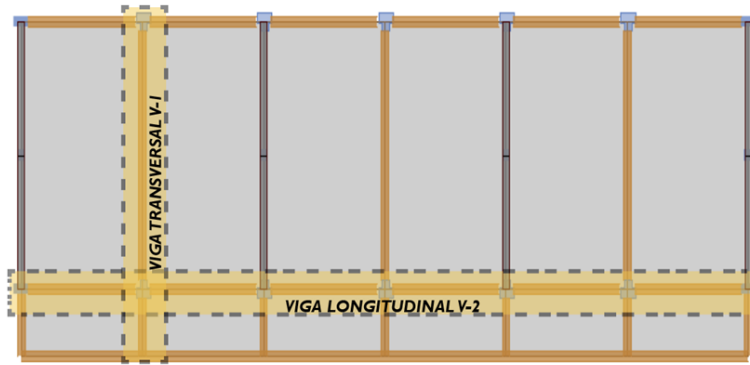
Ubicación de viga longitudinal y viga transversal
